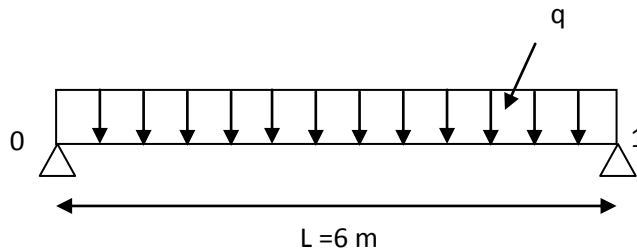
Schéma statique de la poutre d'étage courant
